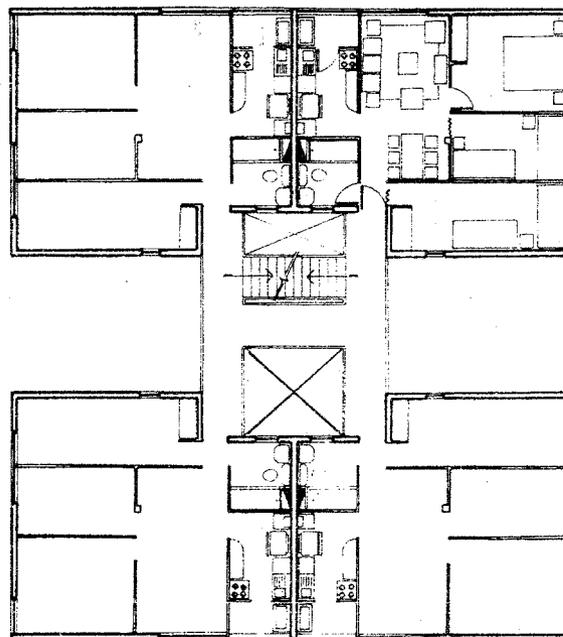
Prototipo de bloque en altura construido por Empresa Viviendas Económicas GAMA S.A.
